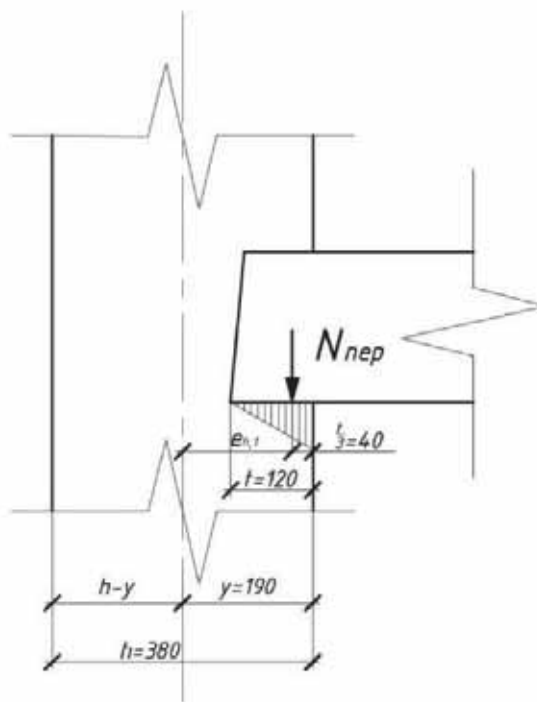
Определение эксцентриситета нагрузки от перекрытия.
